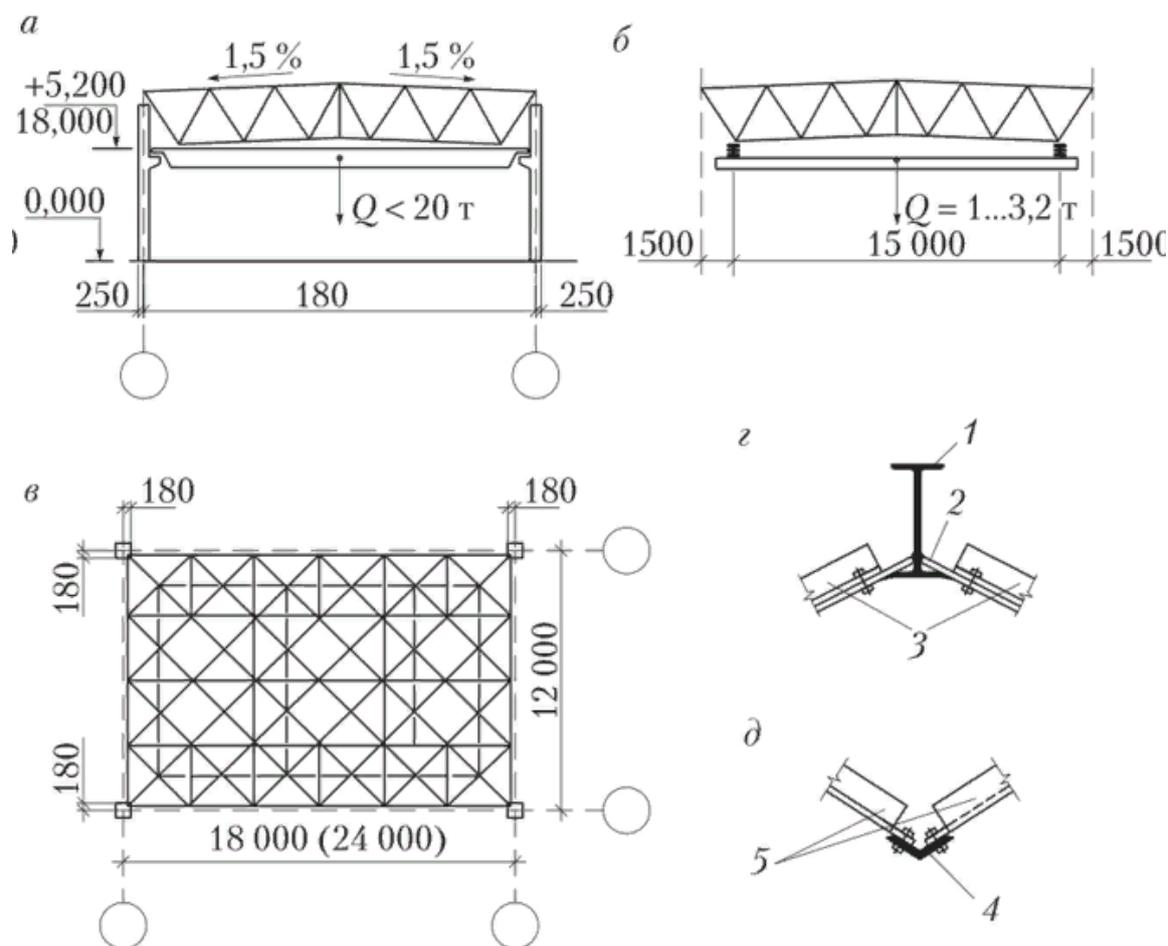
Схема структурного покрытия типа «ЦНИИСК»: а, б - поперечный разрез для зданий с мостовым и подвесным кранами; в - план покрытия; г, д - узлы соответственно верхнего и нижнего поясов; 1 - прогон; 2 - узловые фасонки; 3 - наклонные элементы; 4 - элемент нижнего пояса; 5 - наклонная стойка
